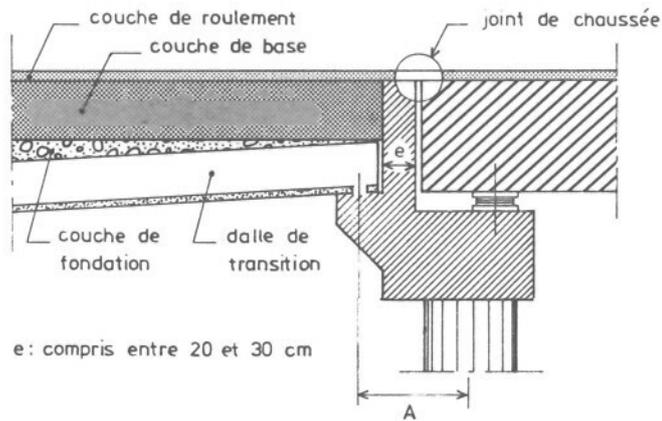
APPUI DE LA DALLE DE TRANSITION
